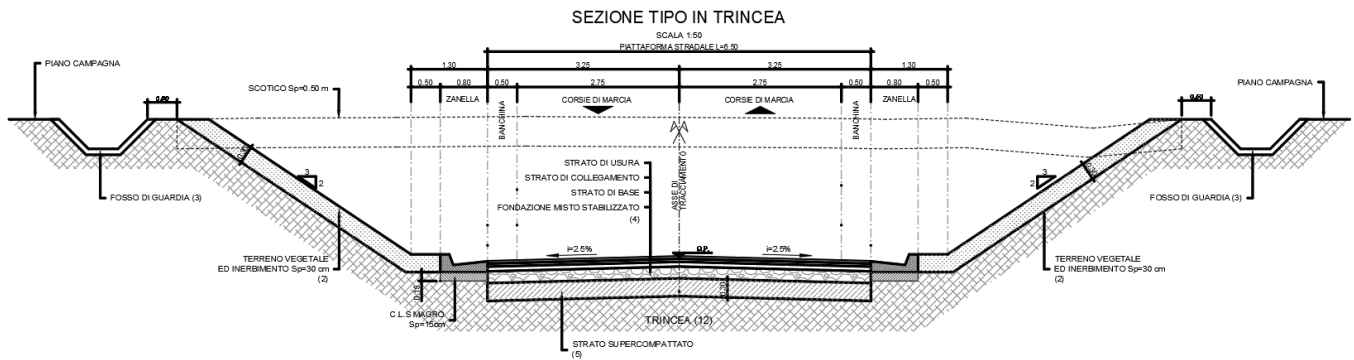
Sezione tipo piattaforma stradale in trincea.
